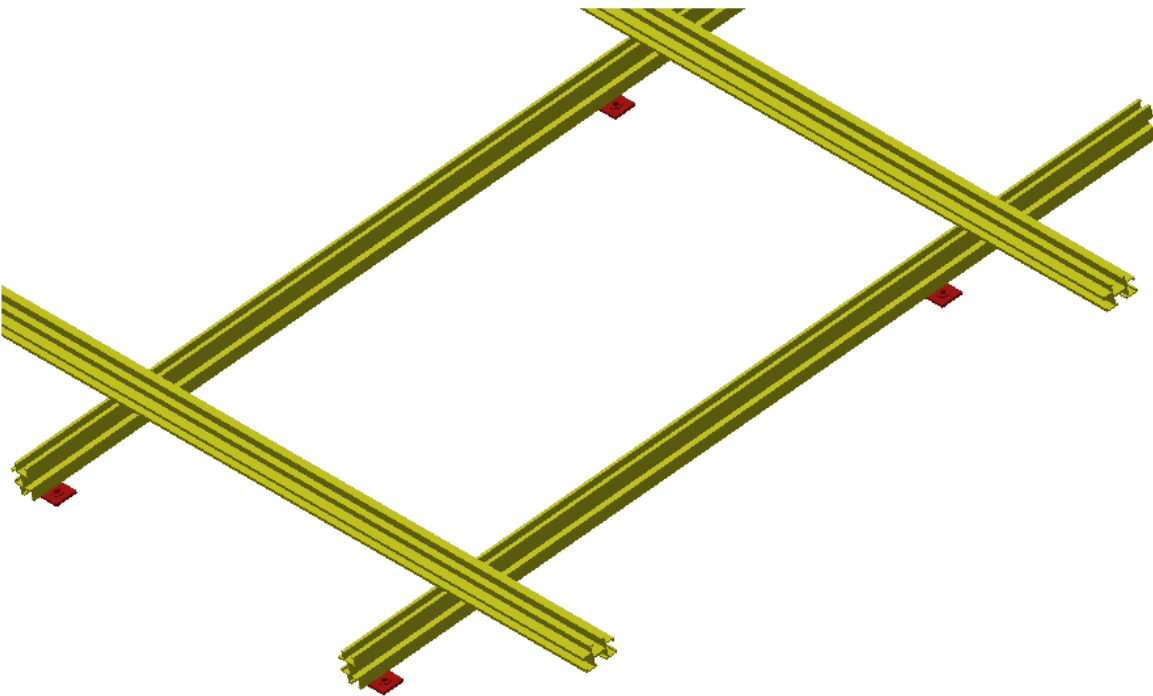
Estructura coplanar. Se destaca en amarillo el perfil de montaje y en rojo la pletina de montaje (no utiliza perfil angular).
